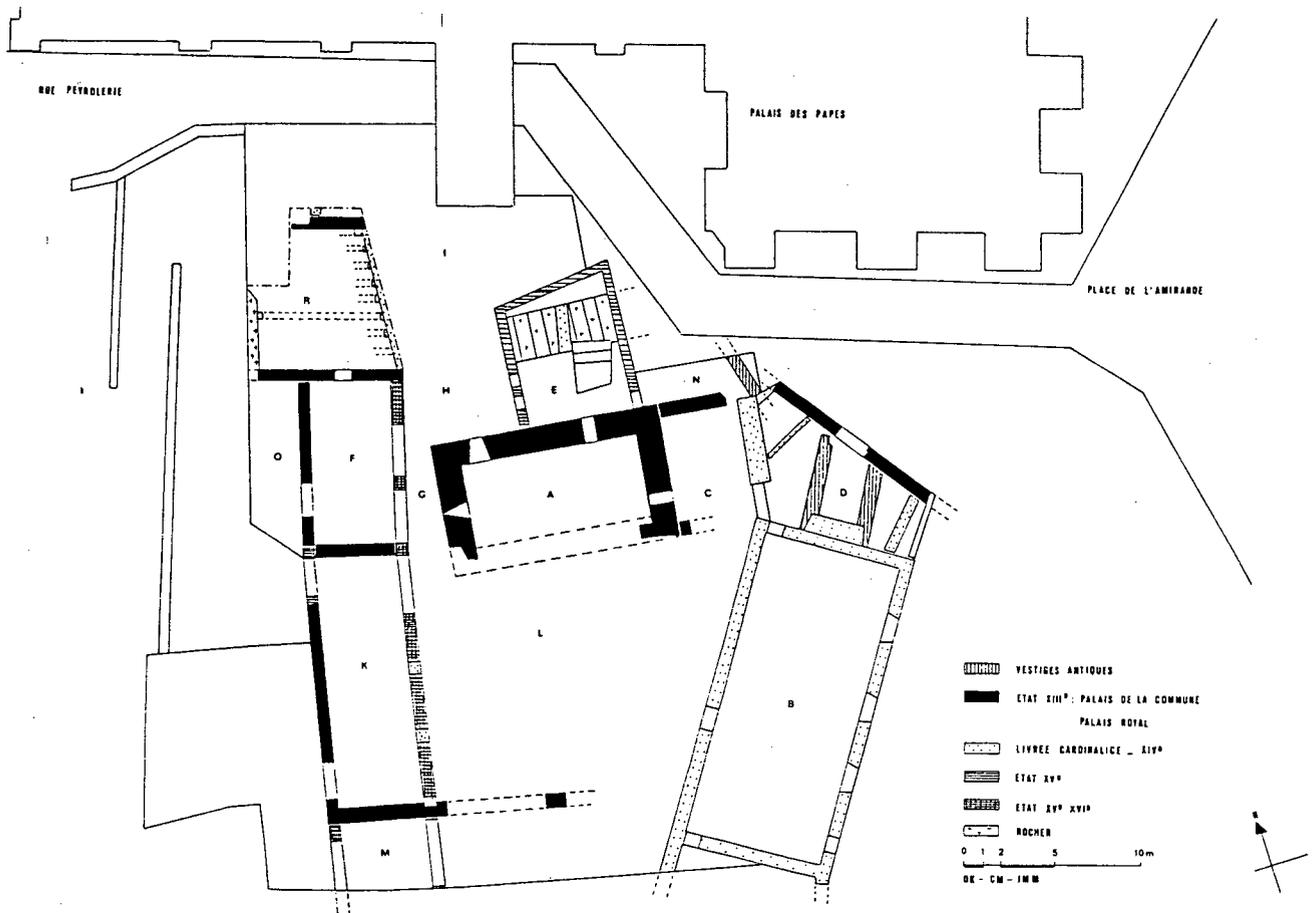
84 - AVIGNON, Vice-Gérance. Plan général des structures.
